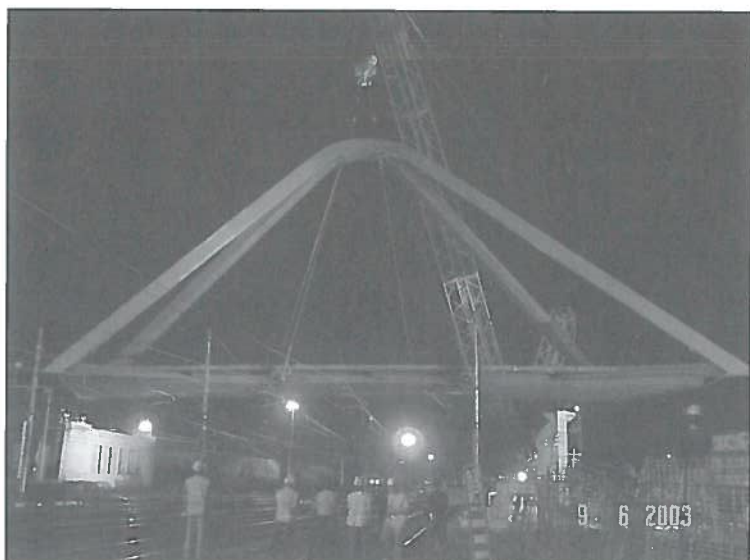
Fasi del varo: l'impalcato è in posizione prima del calaggio sulle pile
